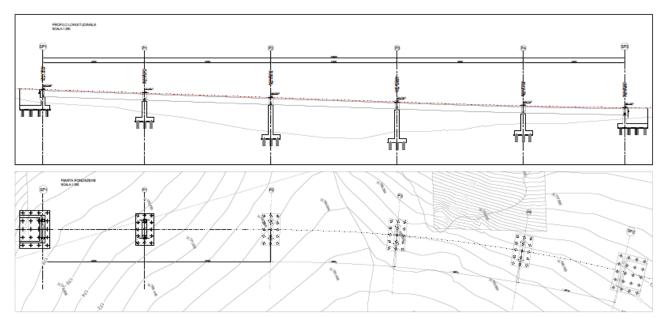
Profilo e pianta delle fondazioni del Viadotto Pieve
